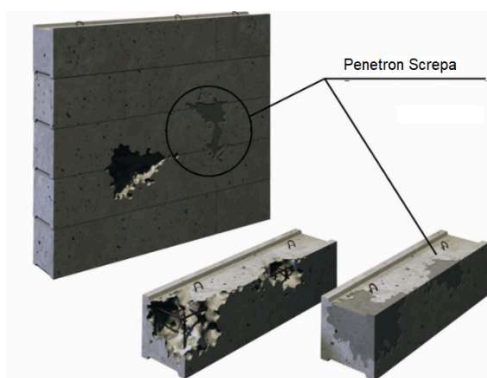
Consolidarea elementelor din beton cu Penetron [3]
